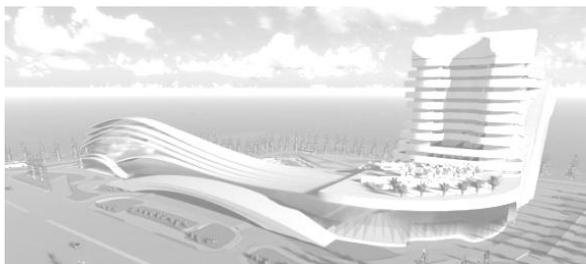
Perspektif dari Jalan Tol Dekat Pintu Tol Amplas
